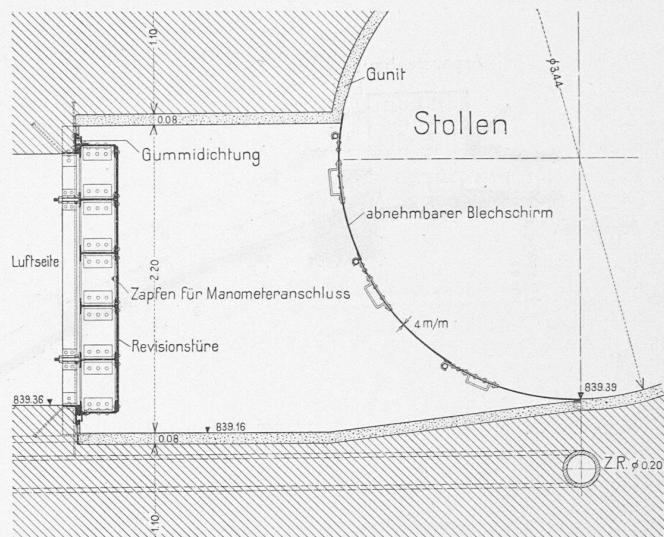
Revisionstüre beim Fenster Bächweid des obern Stollens. — 1 : 50.
